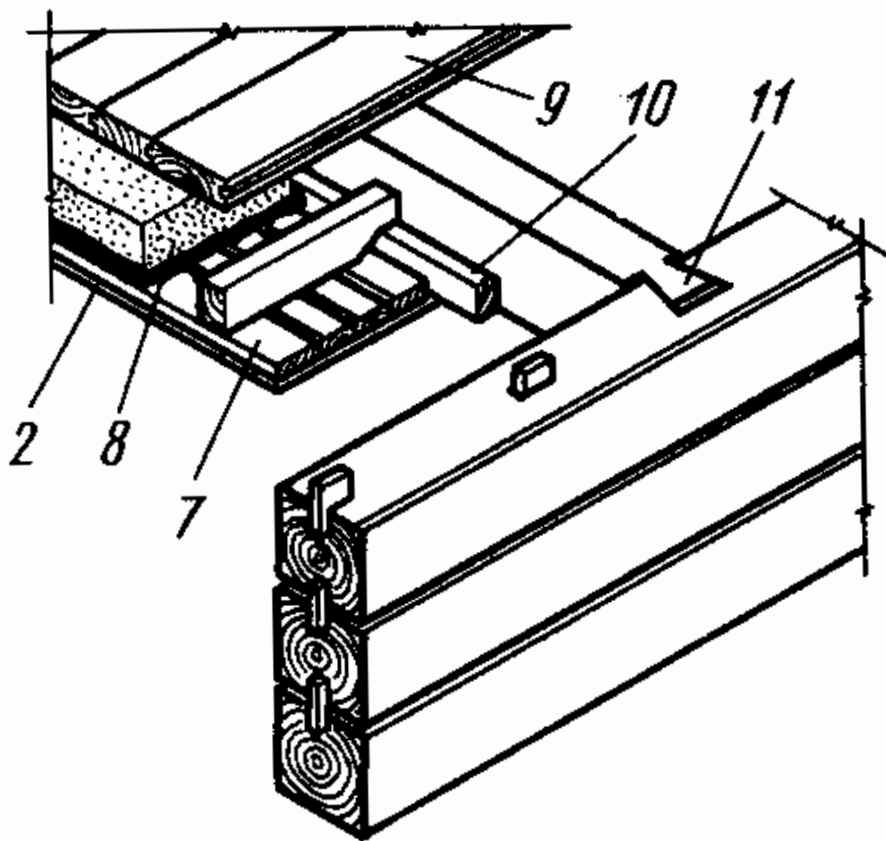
Сопряжение деревянной балки перекрытия с несущей стеной из бруса: 1 – стена из бруса; 2 – пароизоляция; 7 – щит наката; 8 – звукоизоляция (утеплитель); 9 – доски черного пола; 10 – черепной брусок; 11 – врубка «ласточкин хвост»
